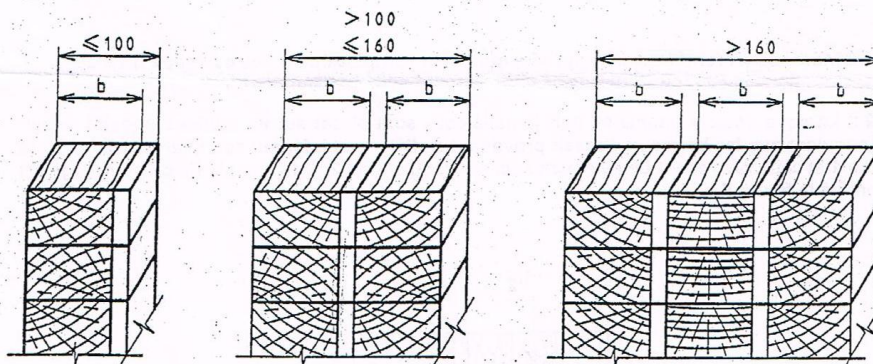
Barreaux d'essais à découper dans la section transversale entière de l'échantillon
